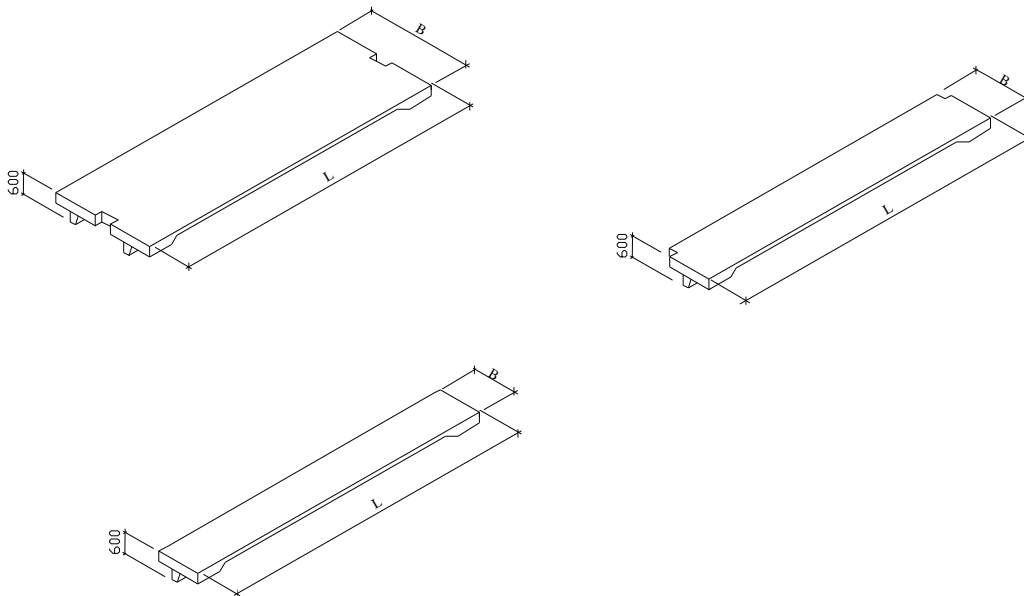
Эскизы конструкций плит перекрытий (окончание)
